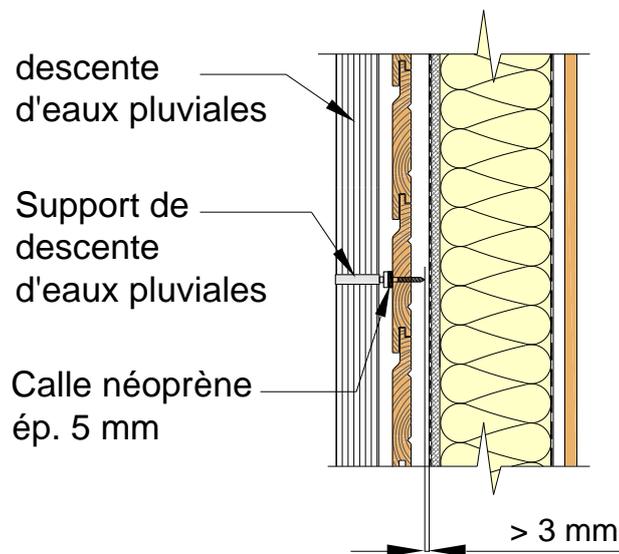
Exemple de fixation d'un support de descente d'eaux pluviales (coupe verticale)
